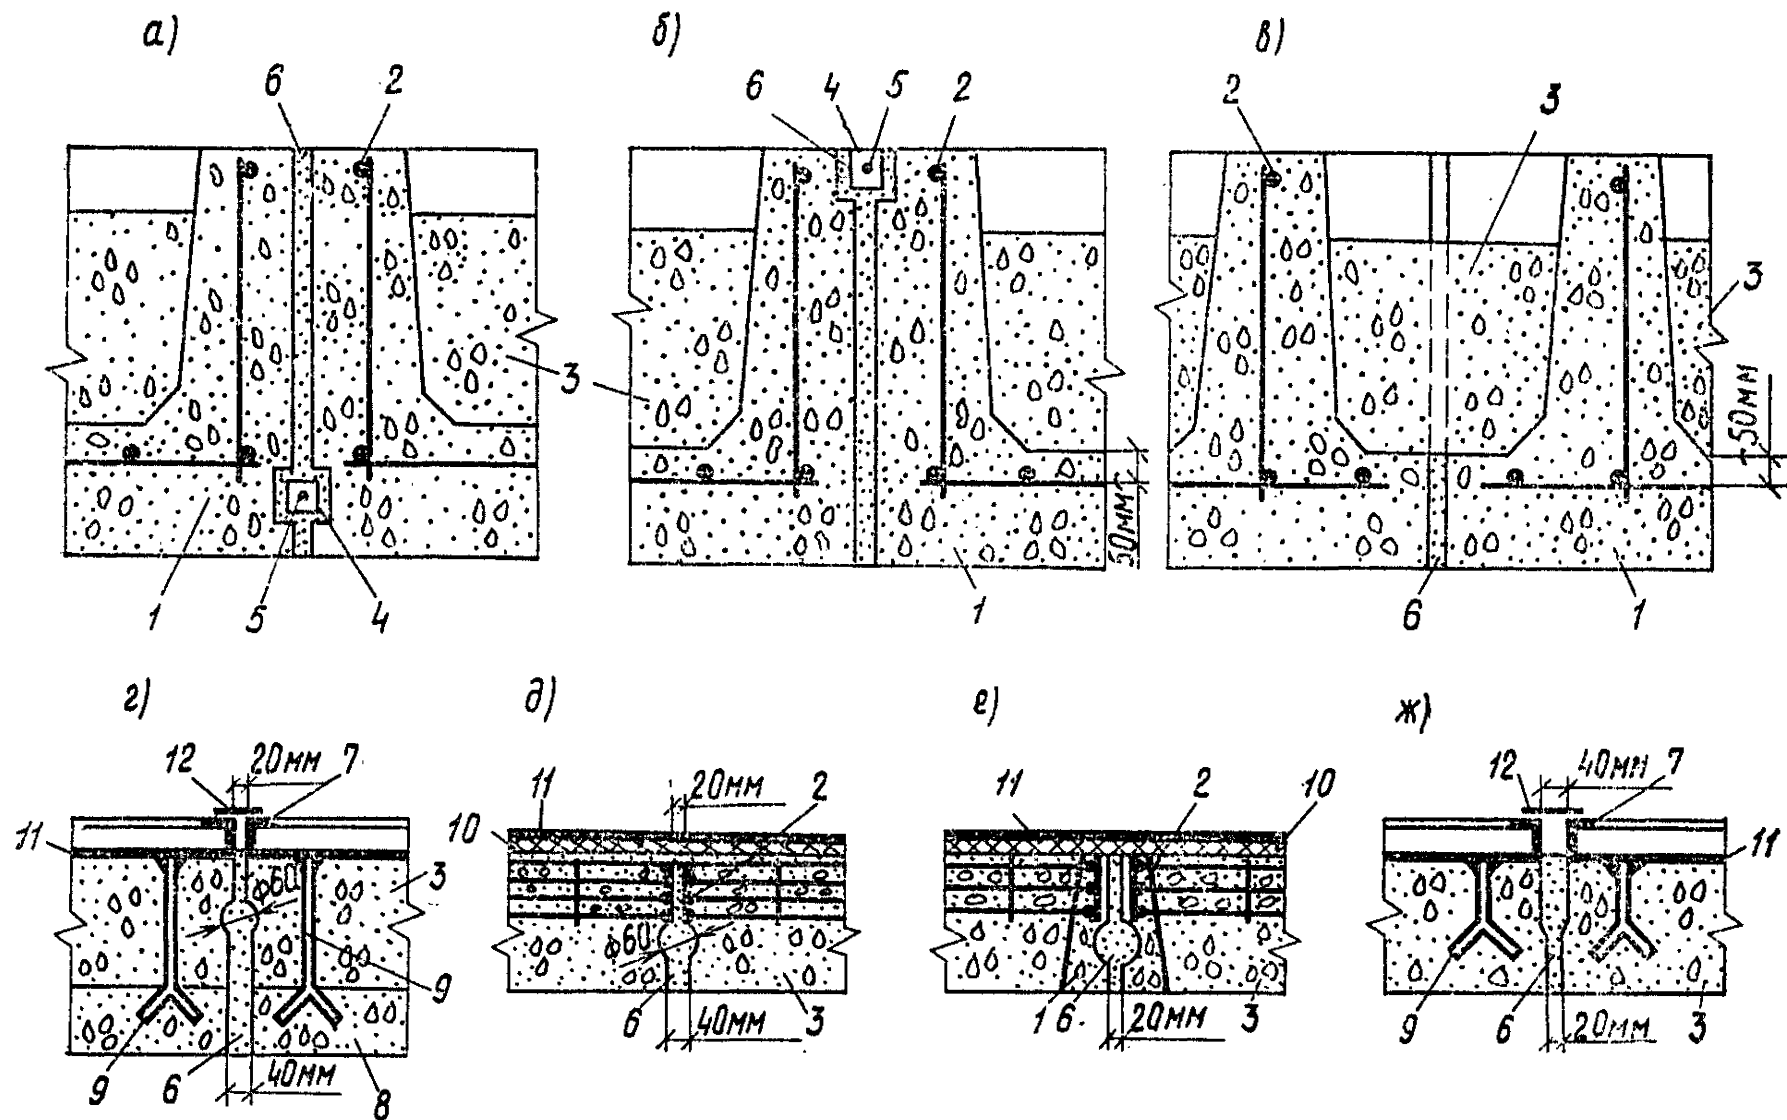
Стыки элементов сборных конструкций из жаростойкого бетона
